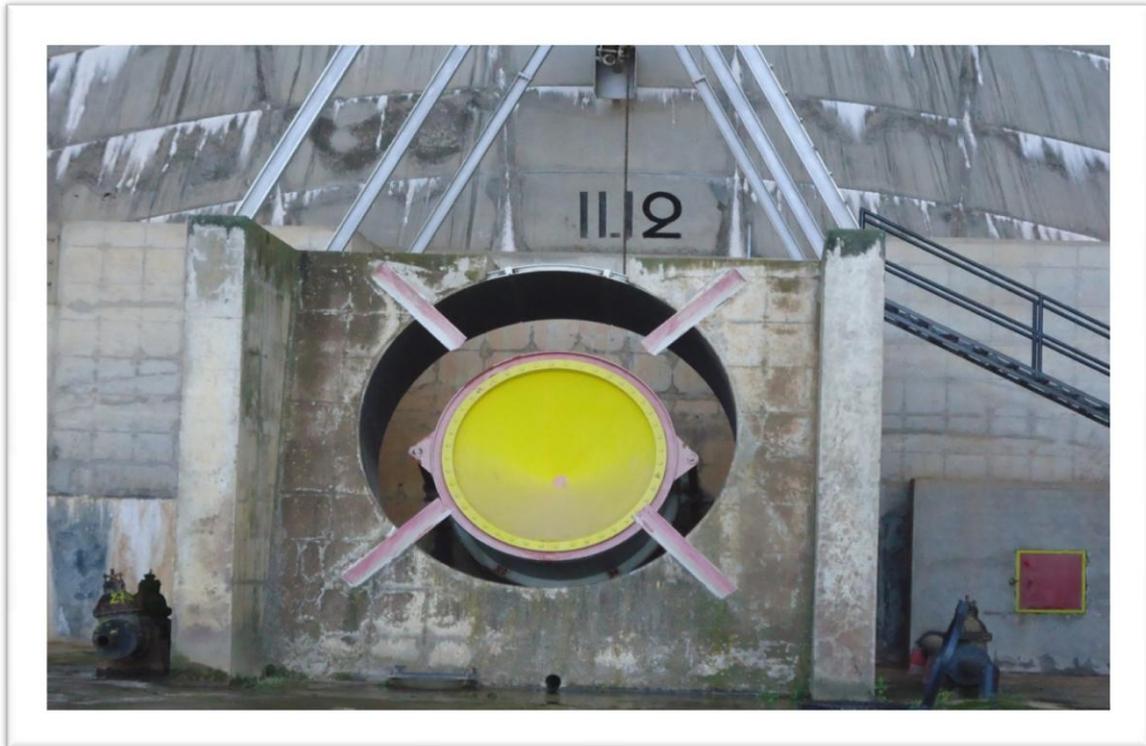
Photo de la vidange de fond prise le 15.05.2014.
